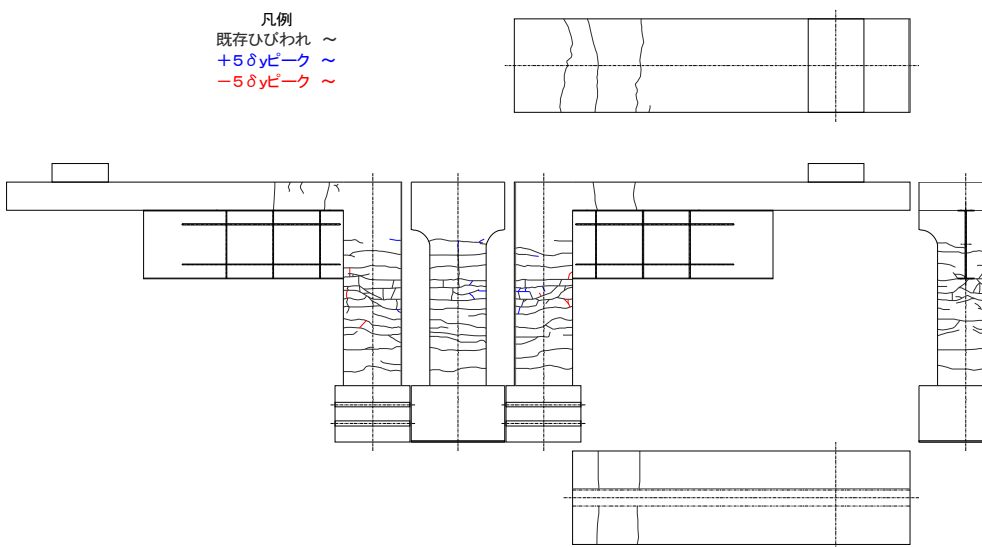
ひび割れ損傷図 (その 1)
